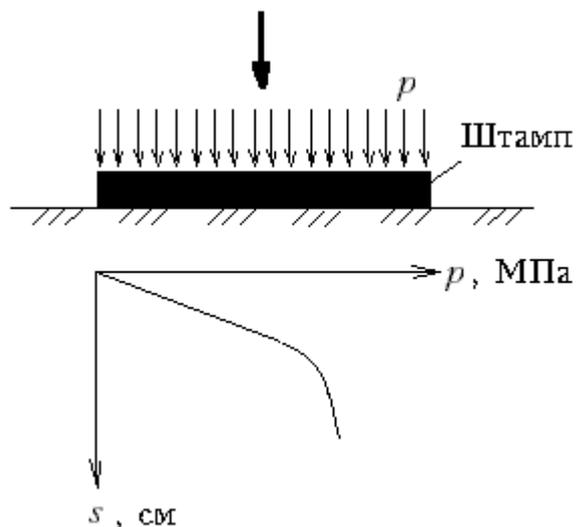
Штаповые испытания грунта в котловане в полевых условиях
